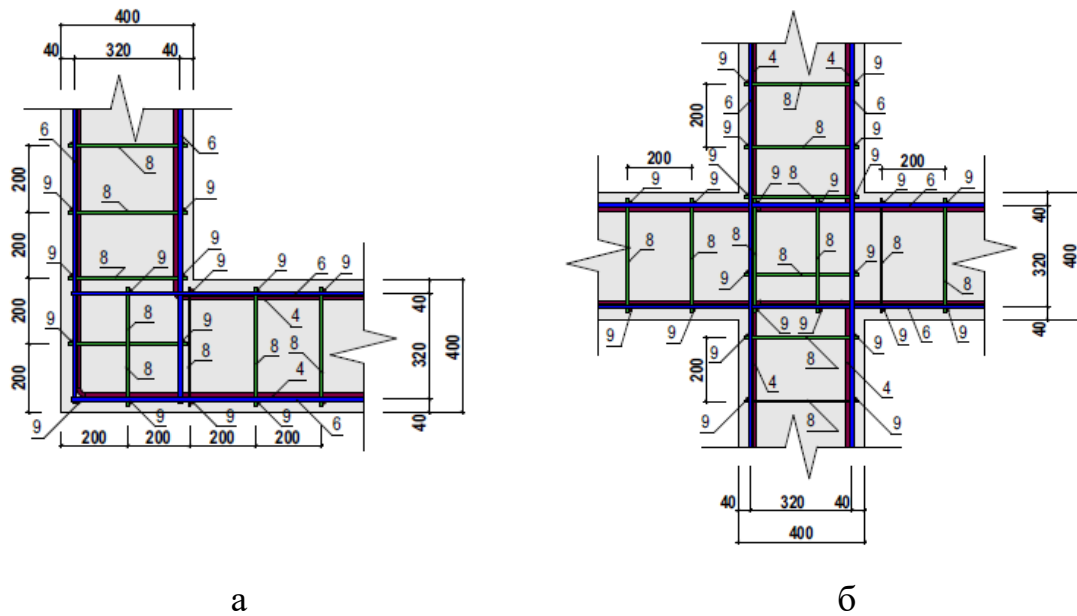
Вузли армування фундаменту: а – кута будинку; б – перетину
